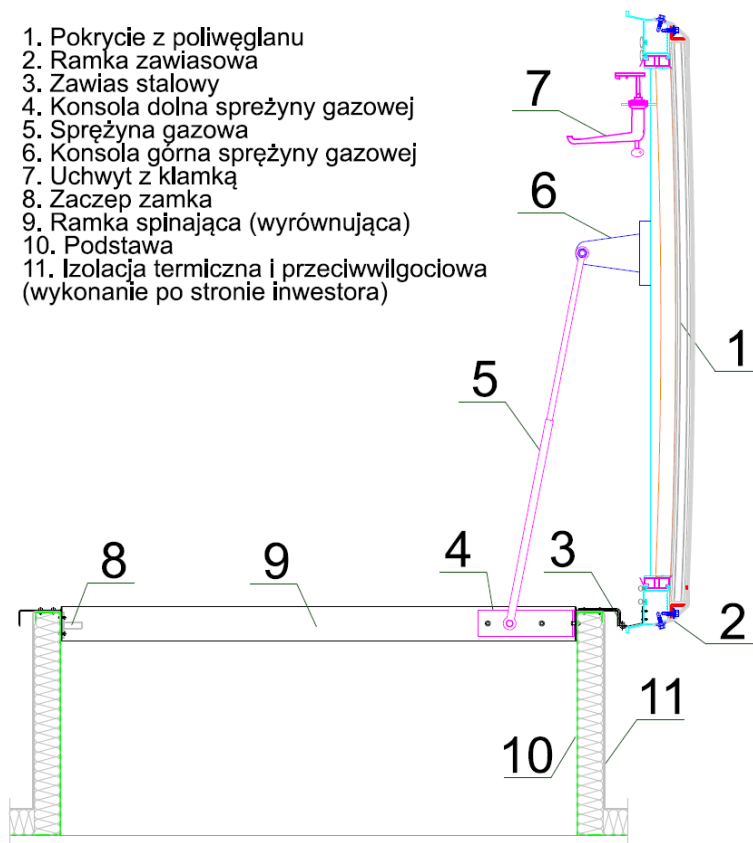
Przekrój przez konstrukcję wylazu dachowego, podstawa z blachy stalowej
